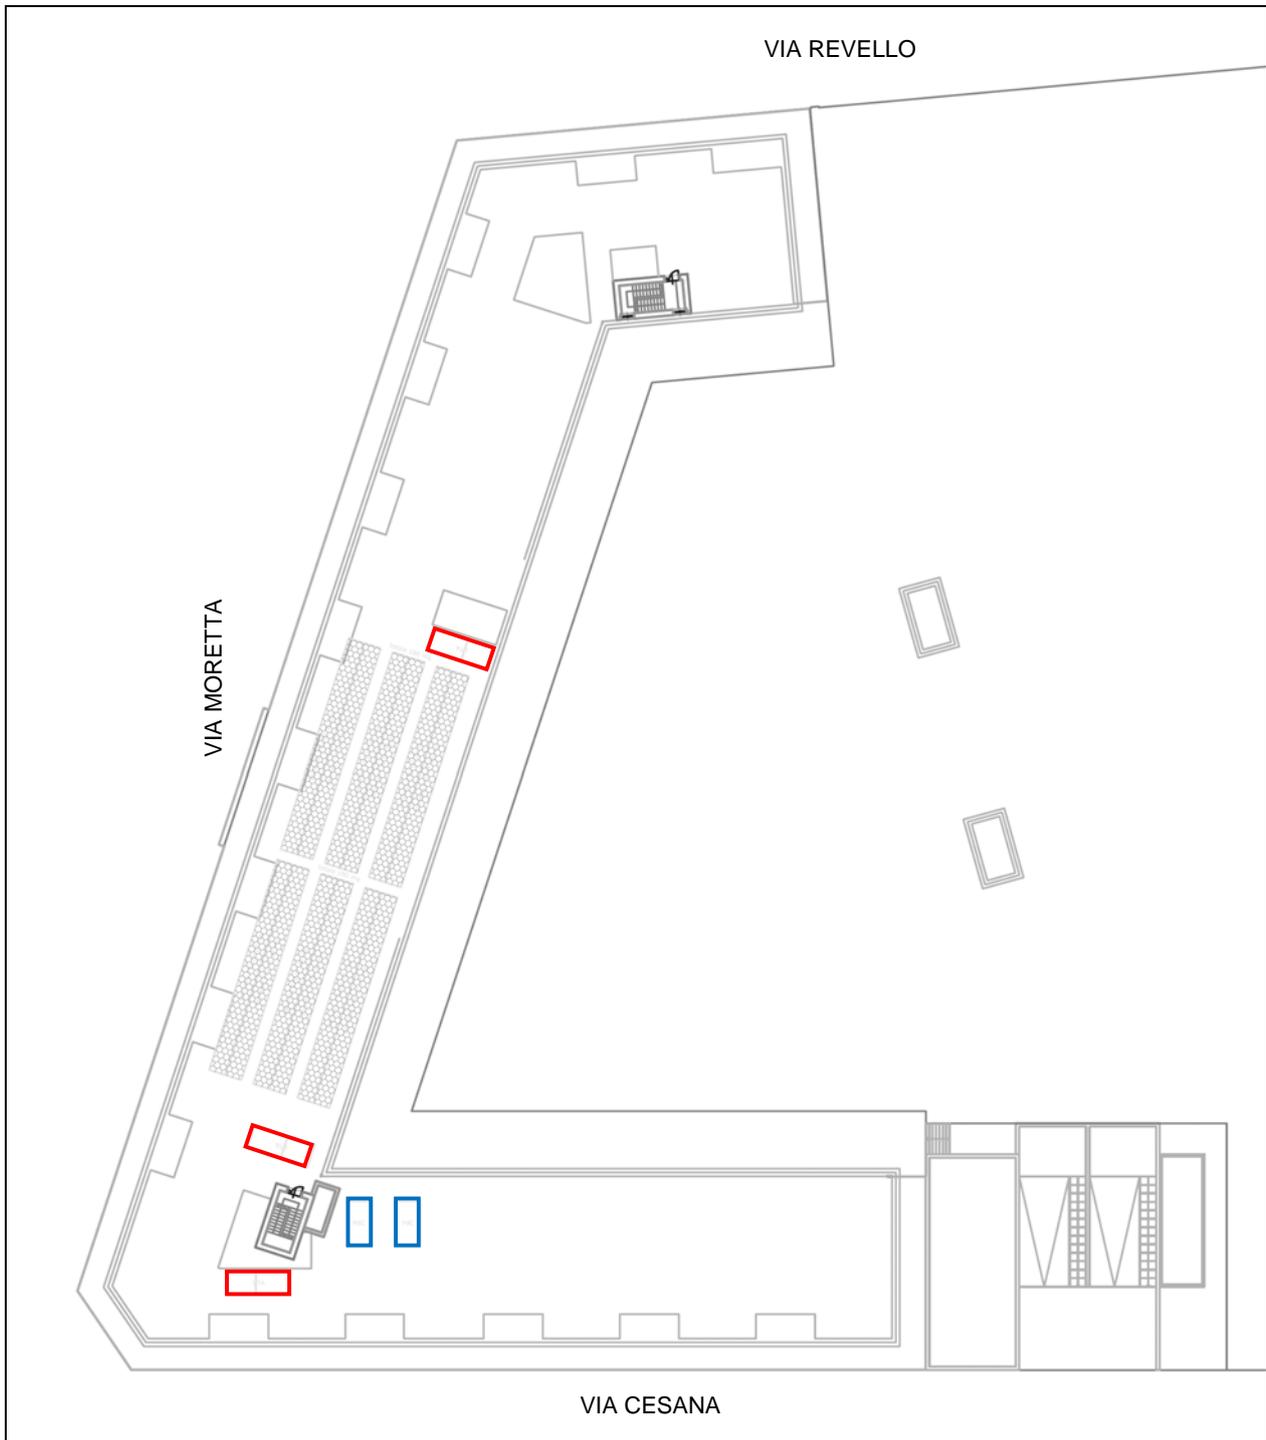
Pianta del piano copertura (+20,6m dal piano campagna) in progetto con indicazione degli impianti tecnologici previsti (in rosso le 3 UTA – in blu le 2 PDC)
